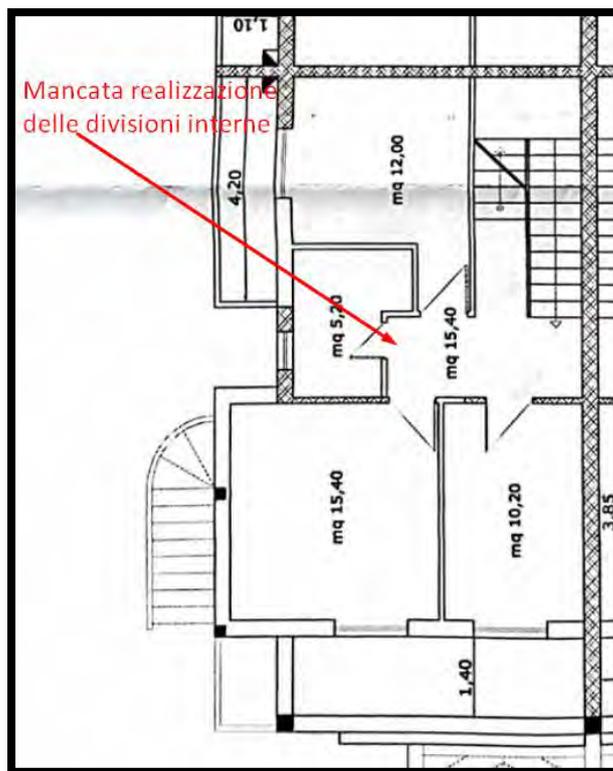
Pianta piano secondo allegata alla CILA prat. n. 294/2011
